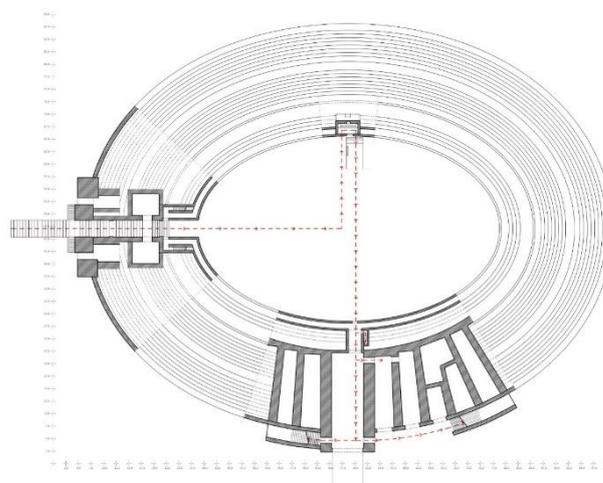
Planta general del anfiteatro de Tarragona con indicación de los sectores propuestos para la reconstrucción.
